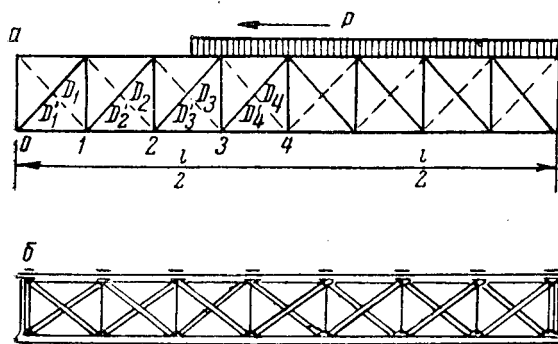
Ферма Гау-Журавского с узловыми подушками:
